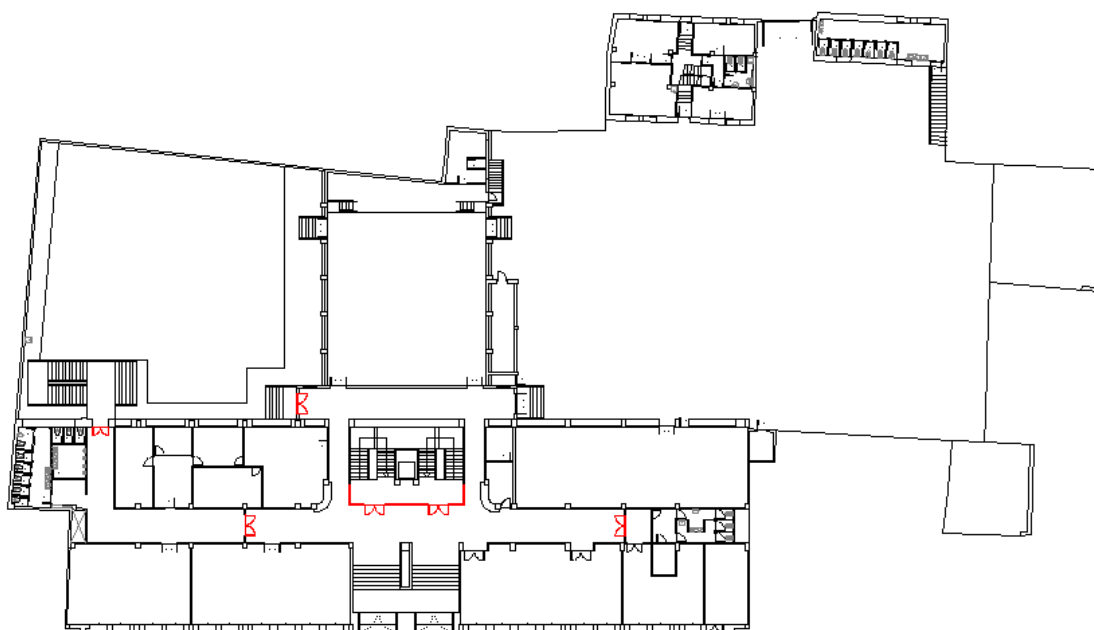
Propuestas de actuación en puertas planta baja. Fuente: Elaboración propia.
